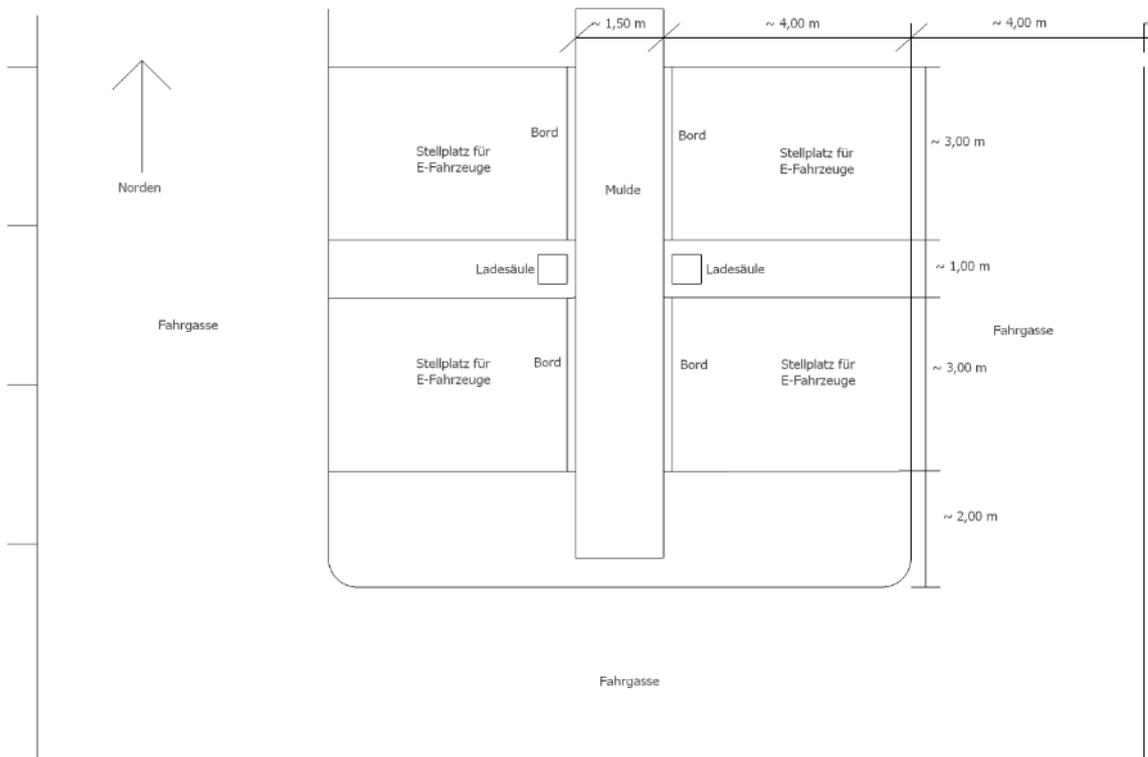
Schematische Lageplanskizze E-Ladestation ASOS
